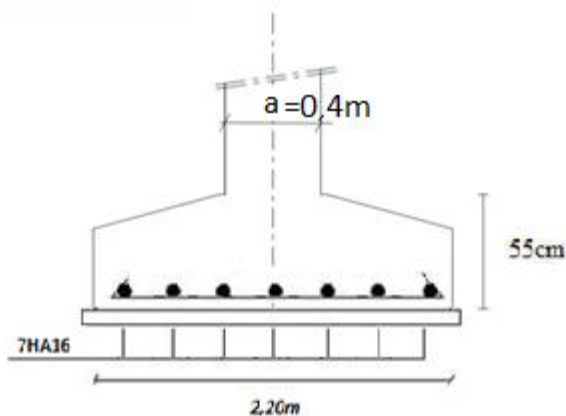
Ferrailage de la semelle intermédiaire dans le sens x-x.
